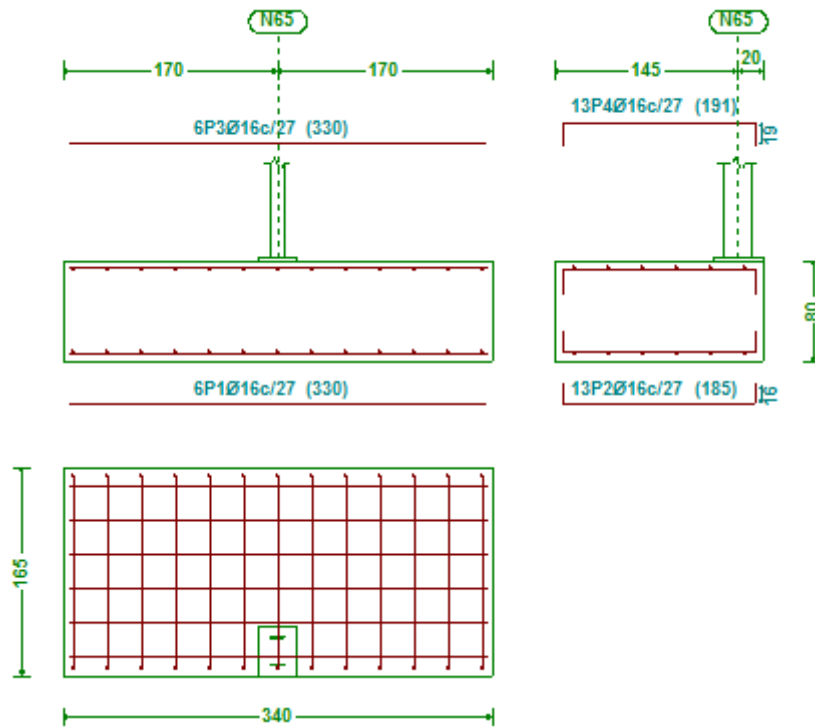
Zapatas pilar interior del pórtico de fachada (Tipo 4)
